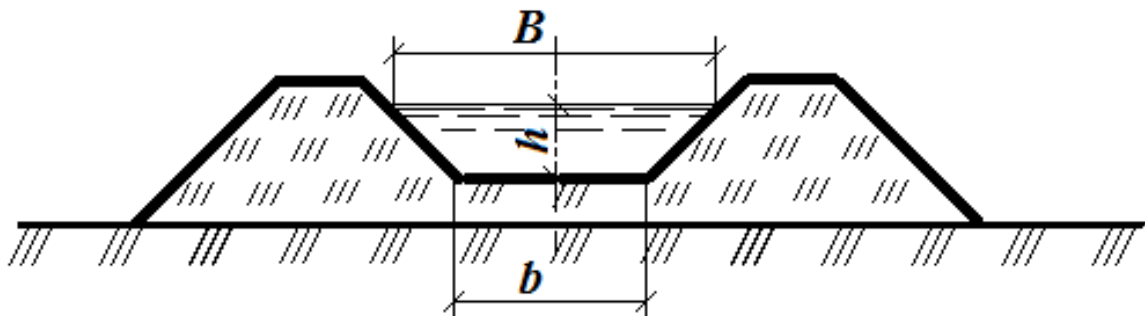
Поперечное сечение оросительного канала в насыпи
